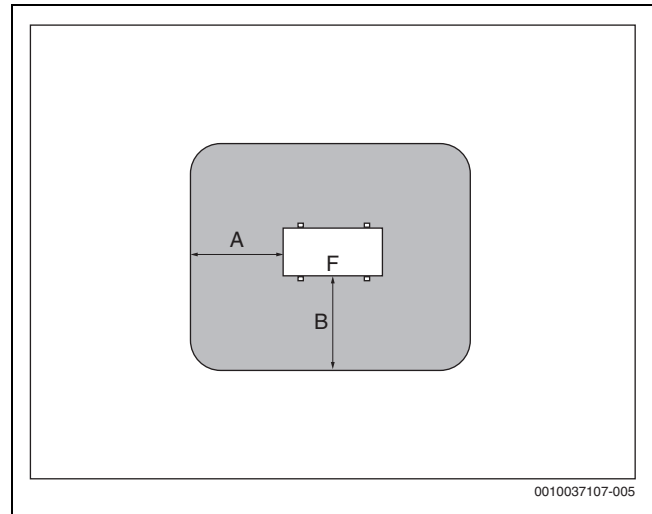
Espace de protection, placement au sol sur un terrain ou sous un toit-terrasse
